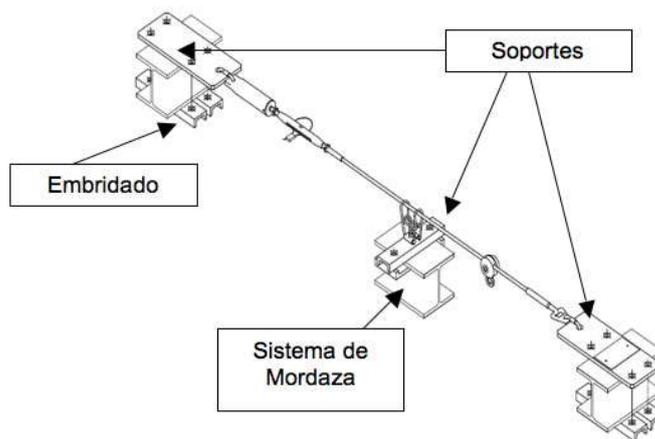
Soportes planos mecanizados en perfil metálico.
